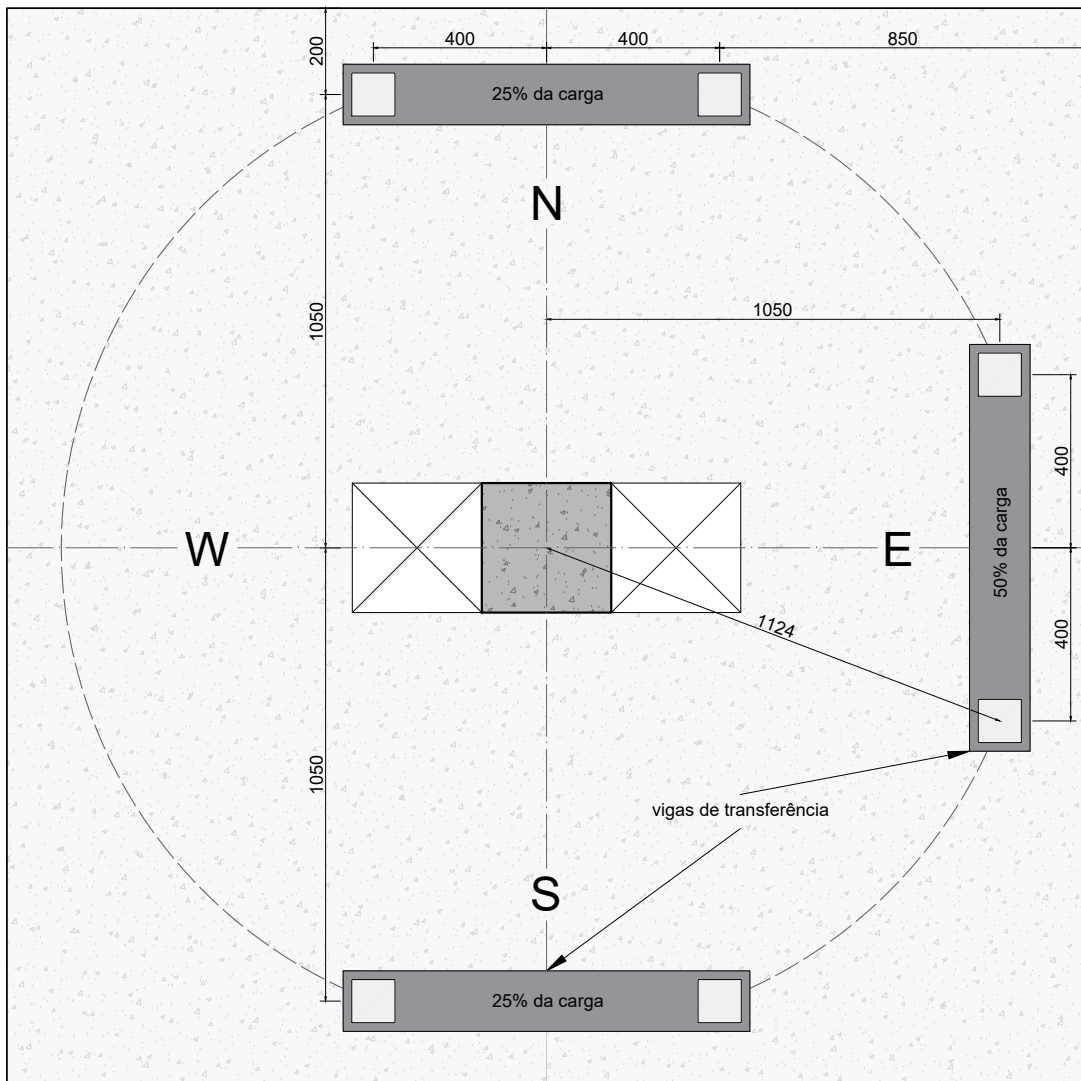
Pontos de aplicação de carga na laje com aberturas [mm]
